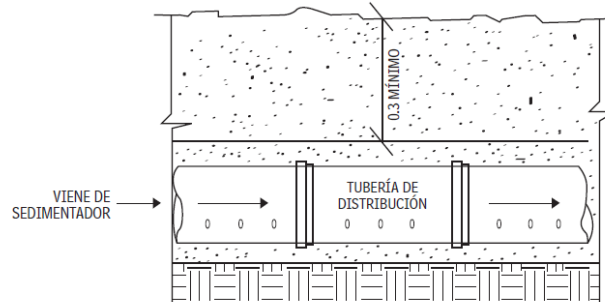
Zanja de infiltración. Vistas en perfil y en corte
